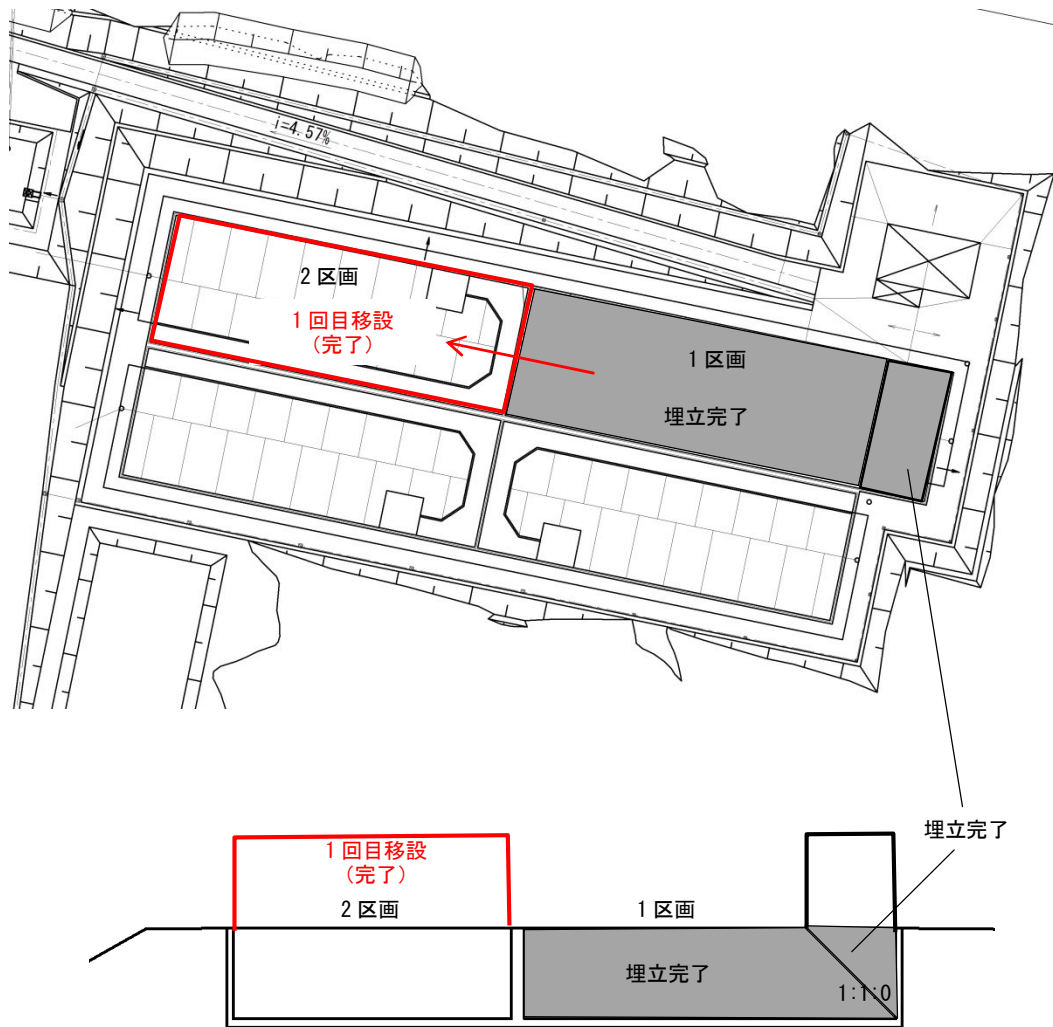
埋立地平面図・標準断面図 (1 回目・上屋移設完了)
